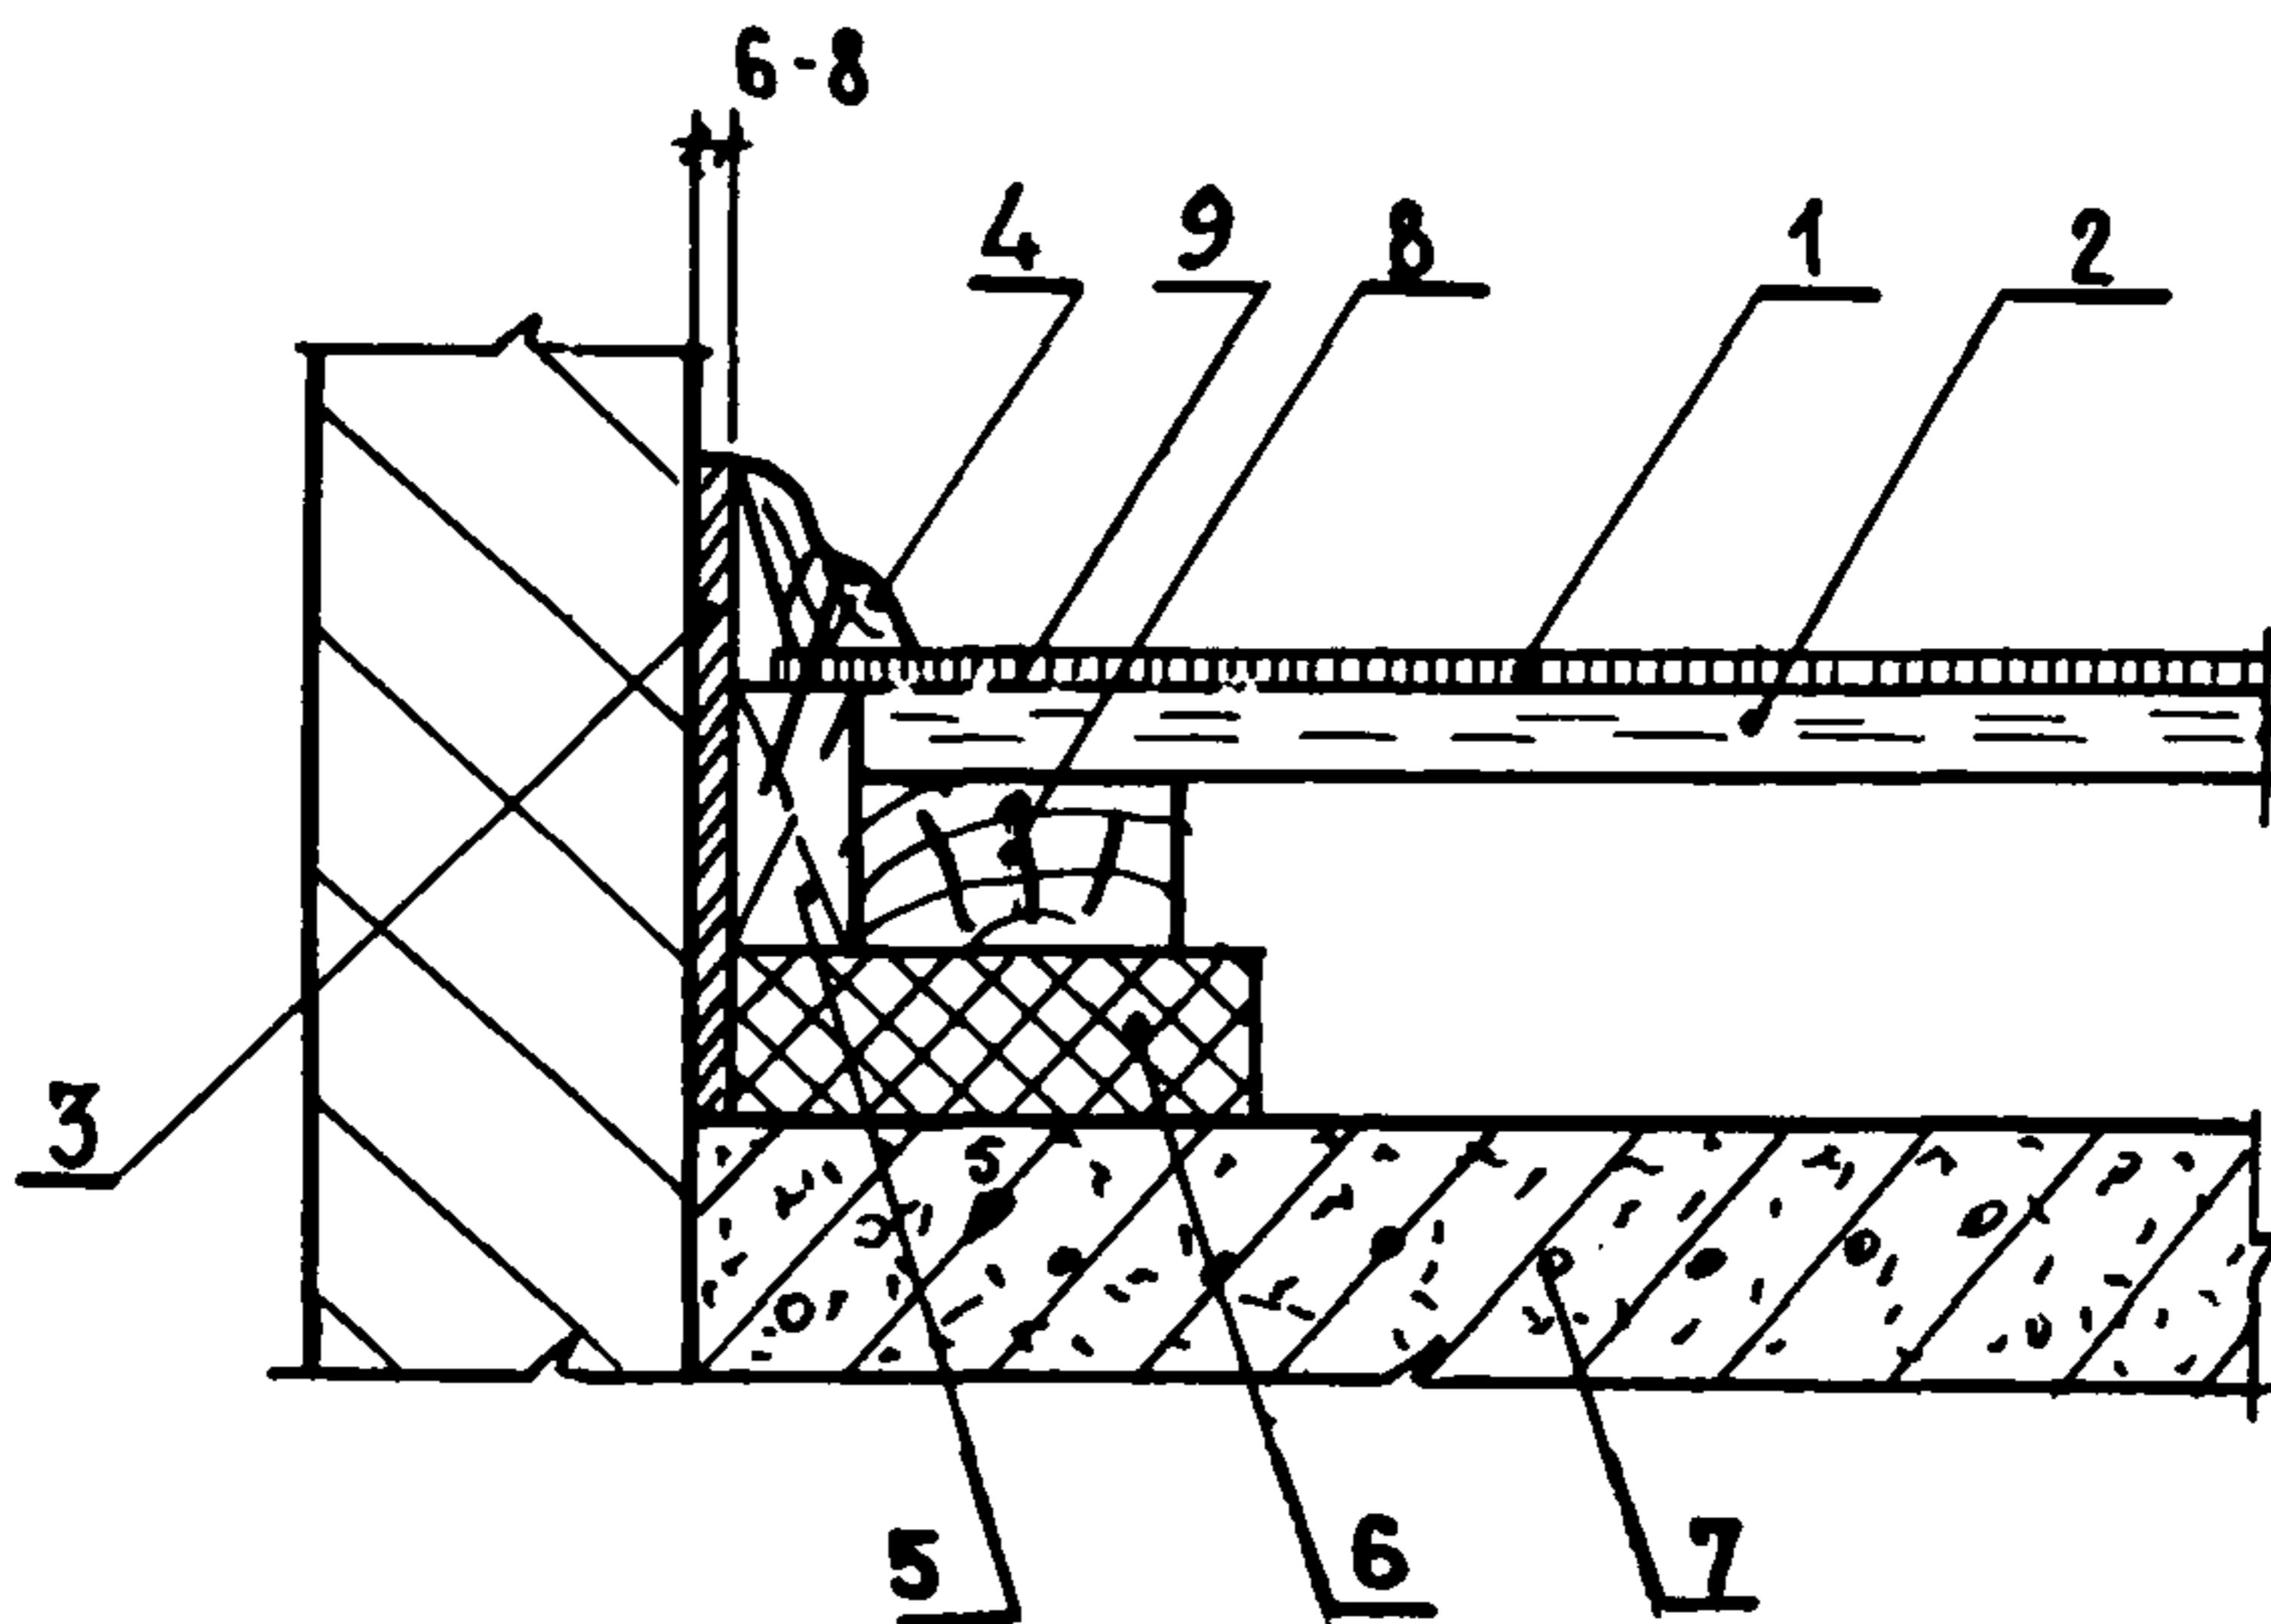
Узел примыкания пола к стенам и перегородкам (вариант полов с древесными основаниями):
